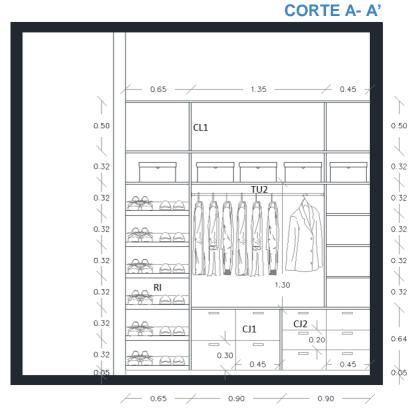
Diseño en alzado A de closet, departamento torre Mitikah. Elaboración conjunta, Álvarez, González, Hurtado. 2022
